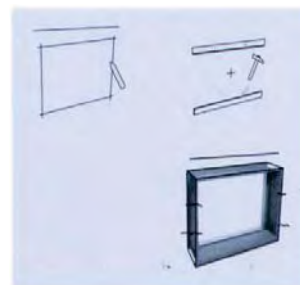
COLOCACIÓN DE MARCO EN MURO DE CONCRETO
